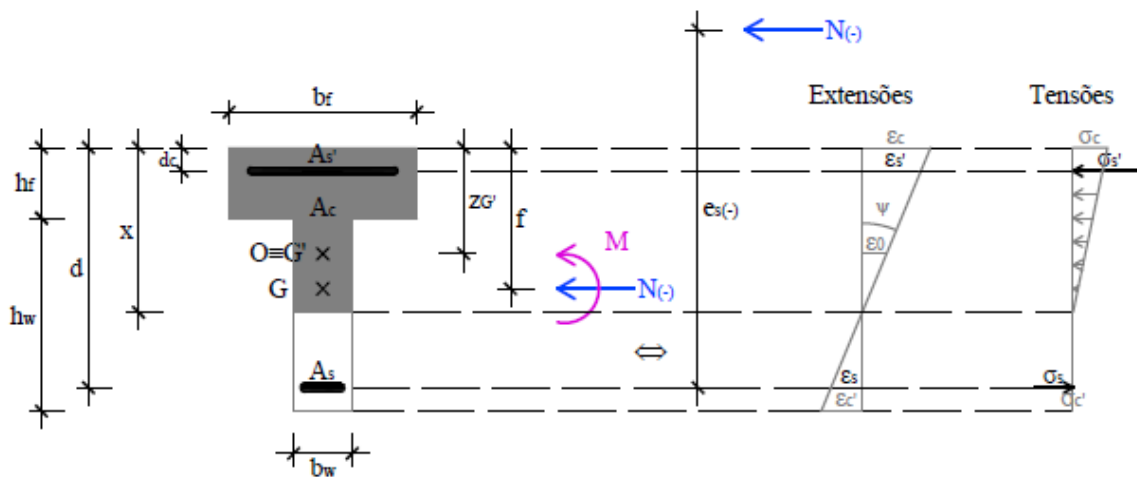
Distribuição de extensões e tensões numa secção fissurada
